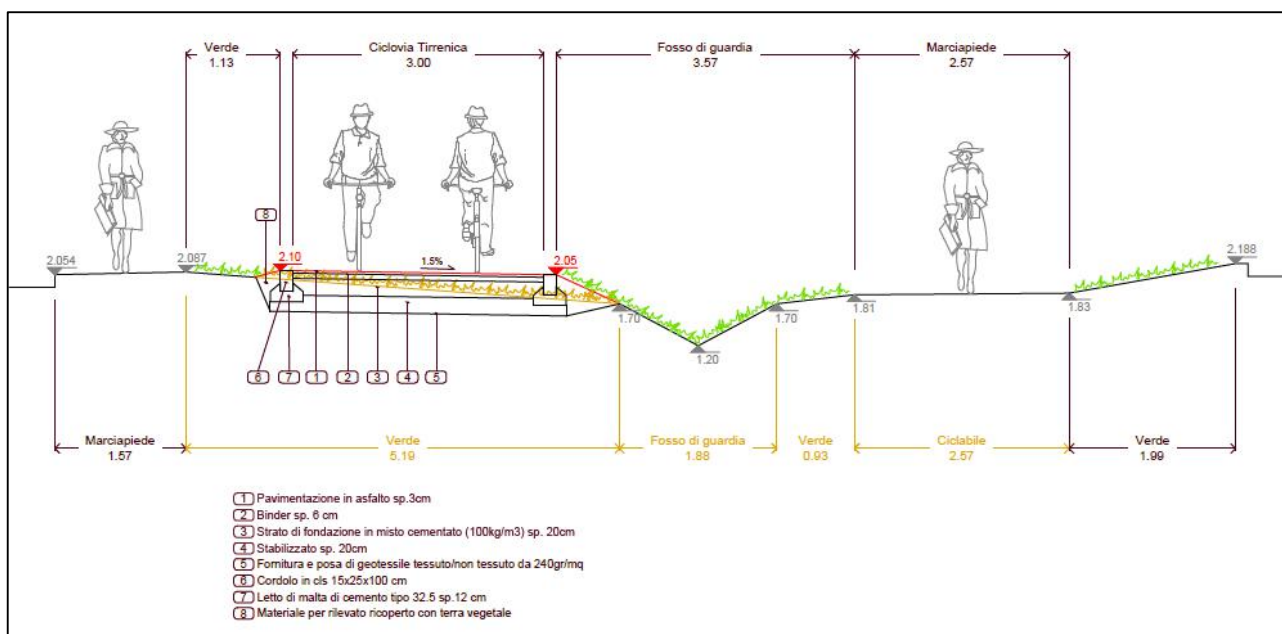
Sezione 12 di progetto trasversale SP delle Collacchie
